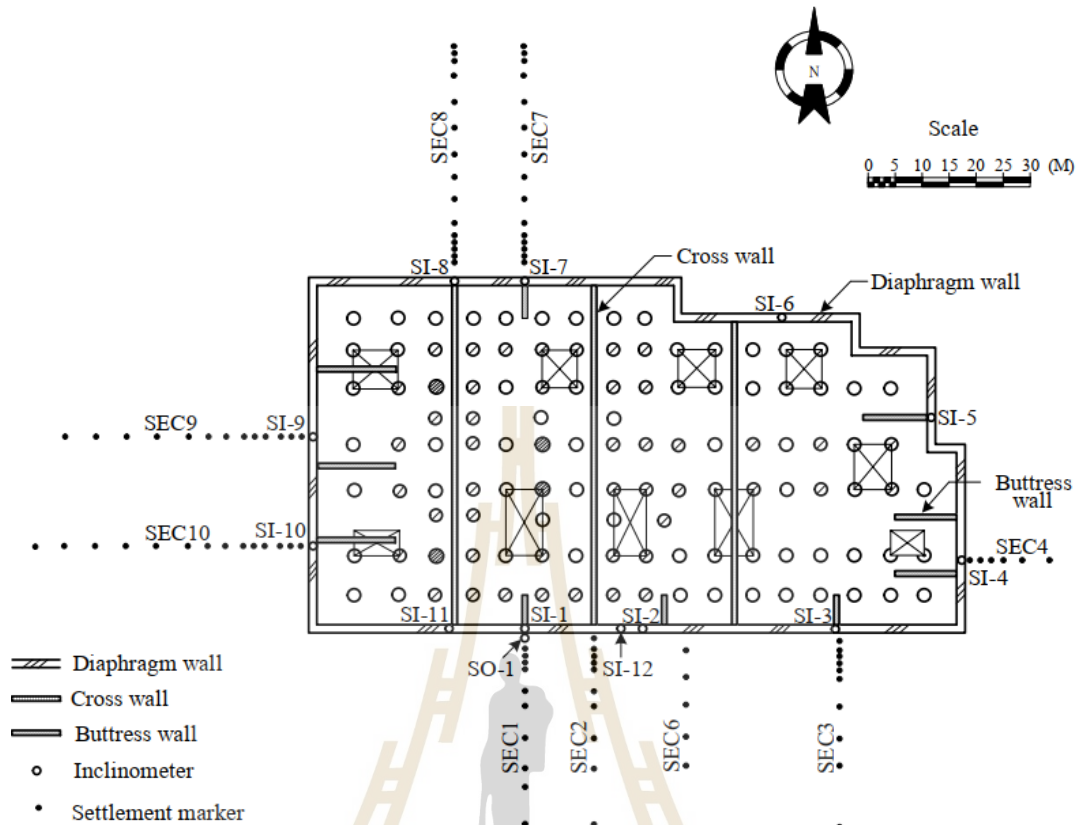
แผนผังของ Cross wall (Ou et al., 2006)
